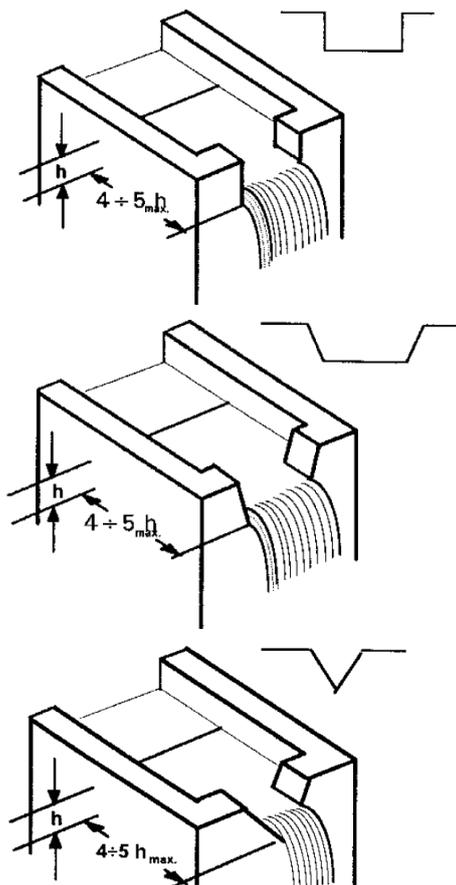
Serbatoi (rispettivamente con stramazzo rettangolare, trapezoidale e triangolare)
